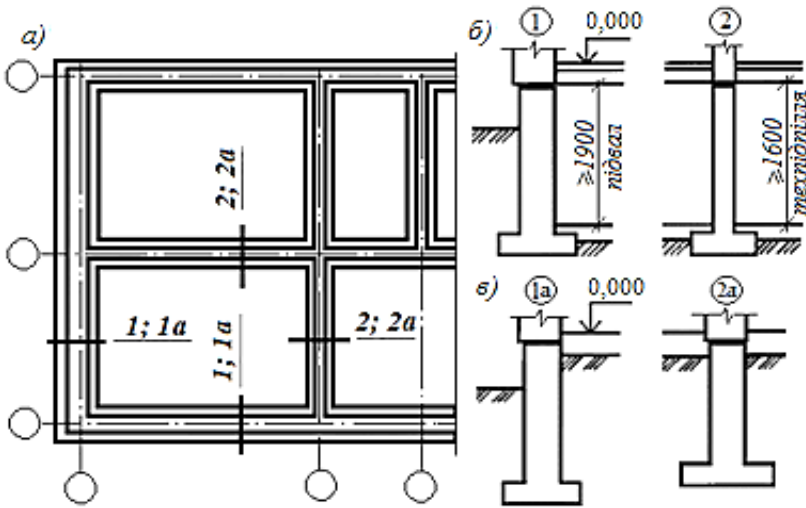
Монолітні стрічкові фундаменти: а – схема плану; б – переріз фундаментів під стіни будівель з підвалами та технічними підпіллями; в – те ж саме, без підвалів
